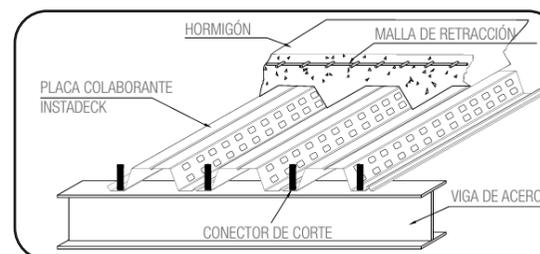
/1 : Detalle Placa Colaborante / Conector de Corte Fuente: cintac.cl / acero-deck.com
